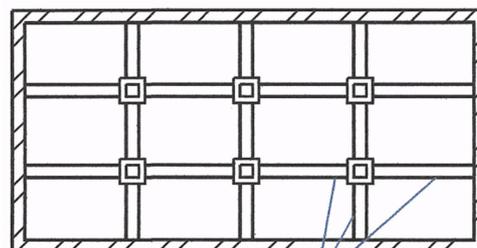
Здание с разной глубиной заложения фундаментов
